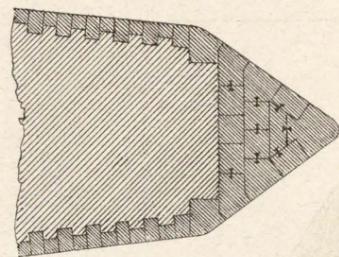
Sezione trasversale sul mezzo della trave mensola. — 1 a 200.
